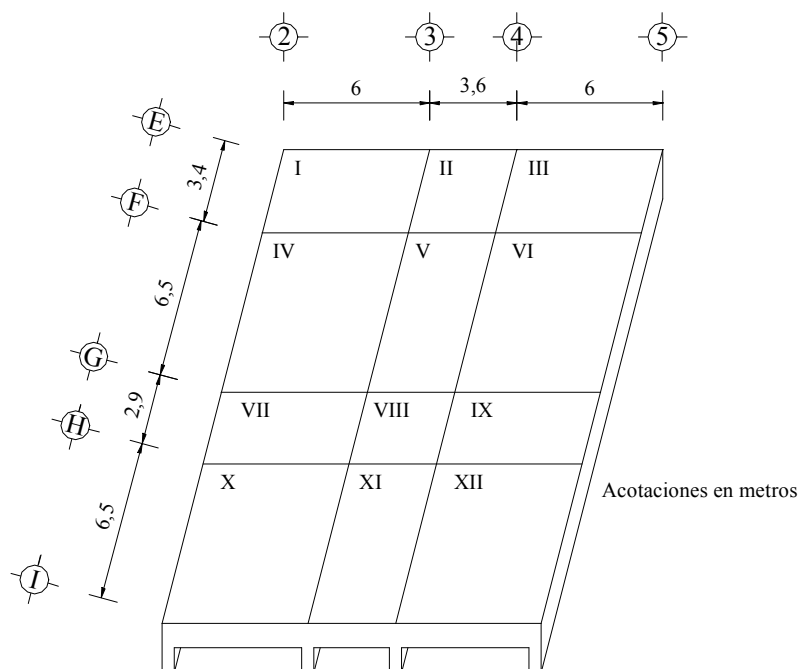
TABLEROS Y CONTRATRABES QUE COMPONEN LA CIMENTACIÓN
